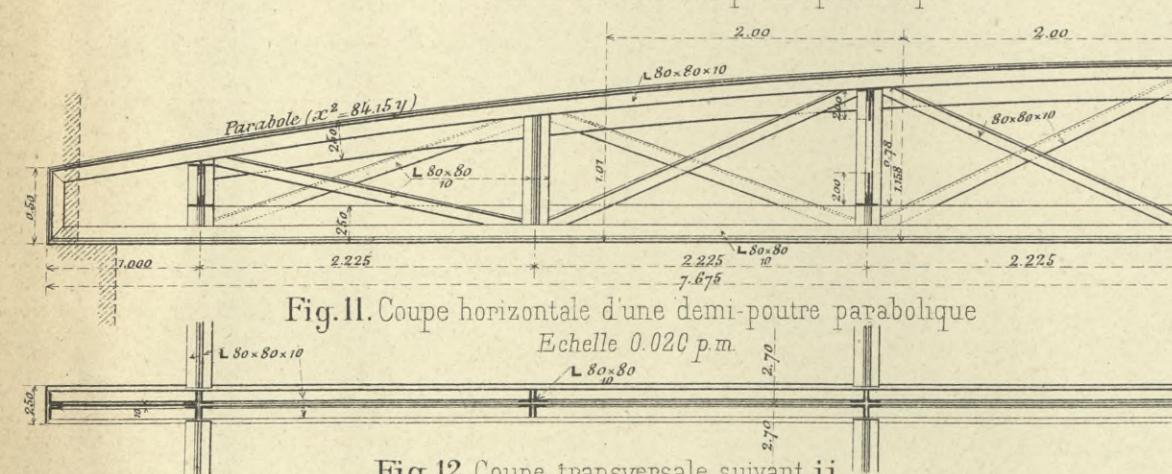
Coupe horizontale d'une demi-poutre parabolique
